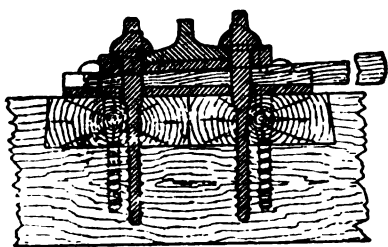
e 15. — Dispositivo per il livellamento delle rotaie. - Sezione e vista.
